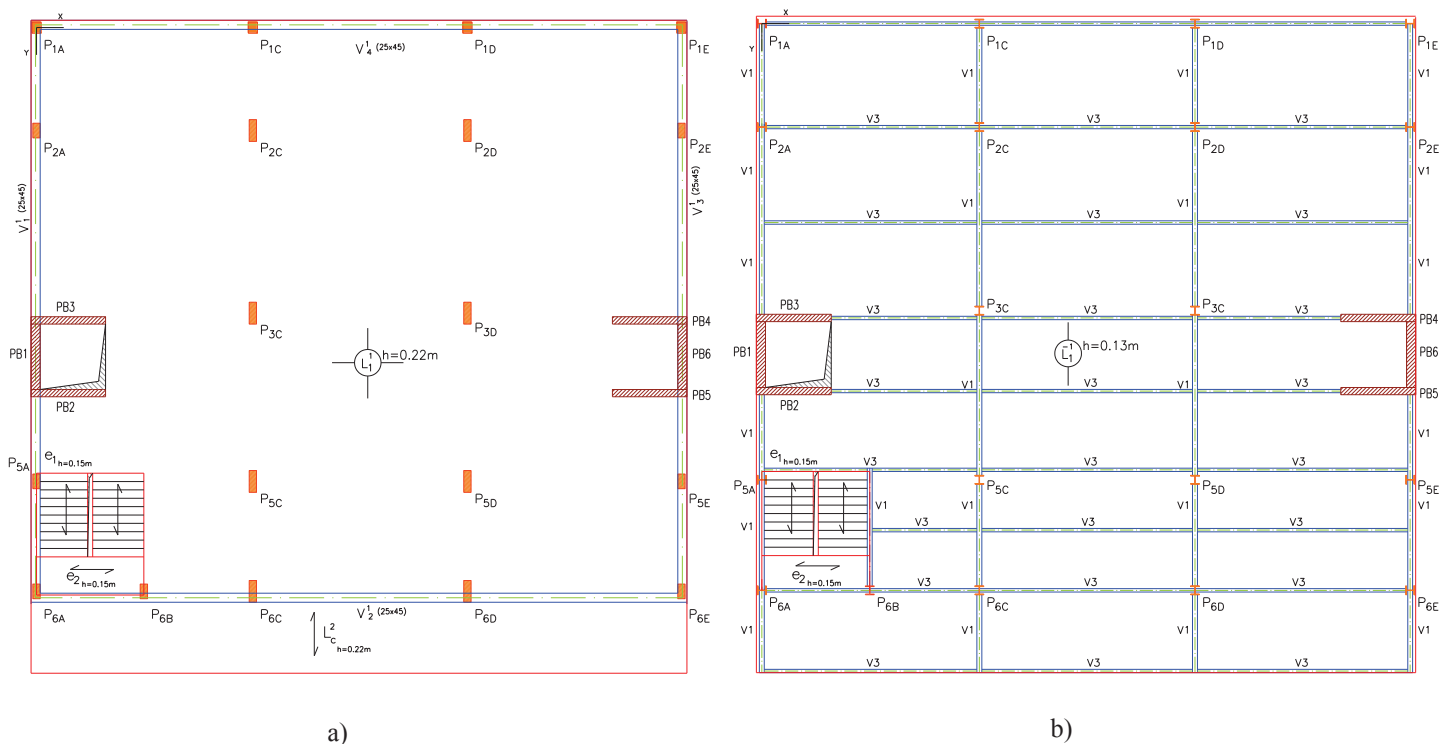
Soluções estruturais (Piso 1): a) solução em betão armado e b) solução metálica
